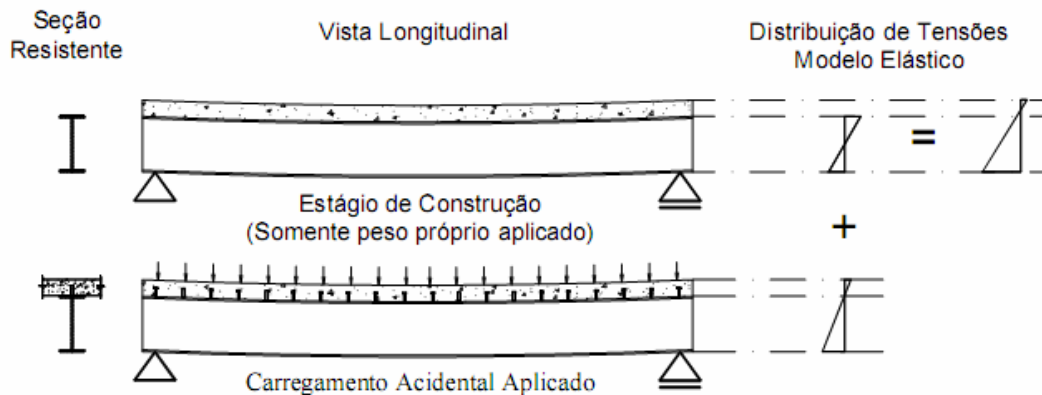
Vigas mistas não escoradas – FABRIZZI (2007)
